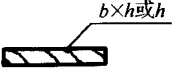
非焊接节点板尺寸的标注方法
